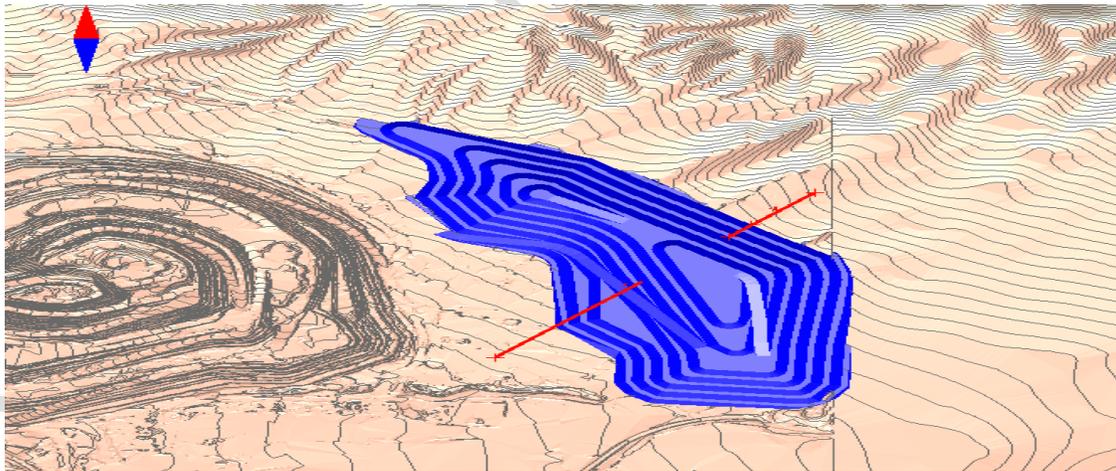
Vista en planta y corte longitudinal de Tepetatera Suroeste
